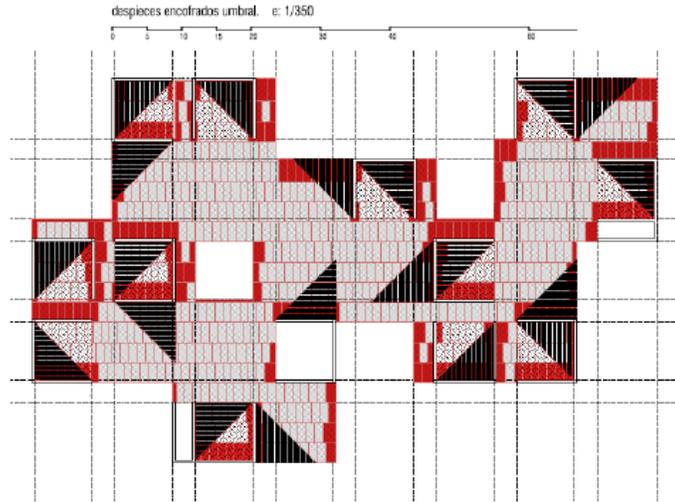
Extracto de la planta de despieces de encofrados del umbral.
